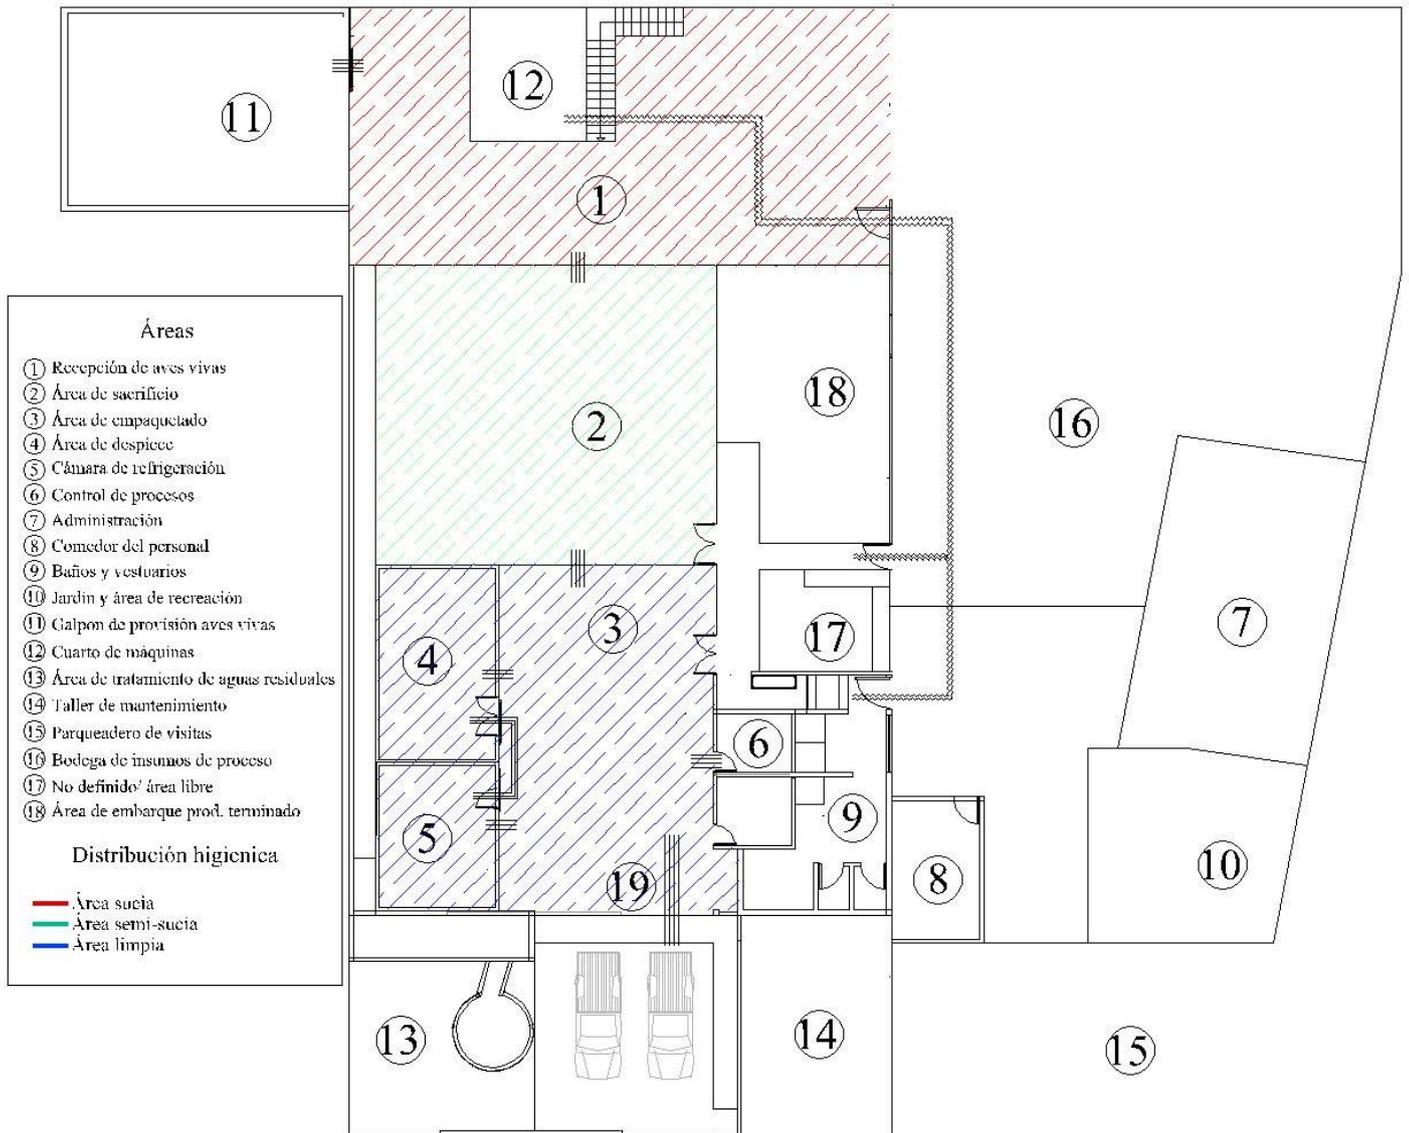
Propuesta de distribución de planta e instalaciones exteriores del local.
